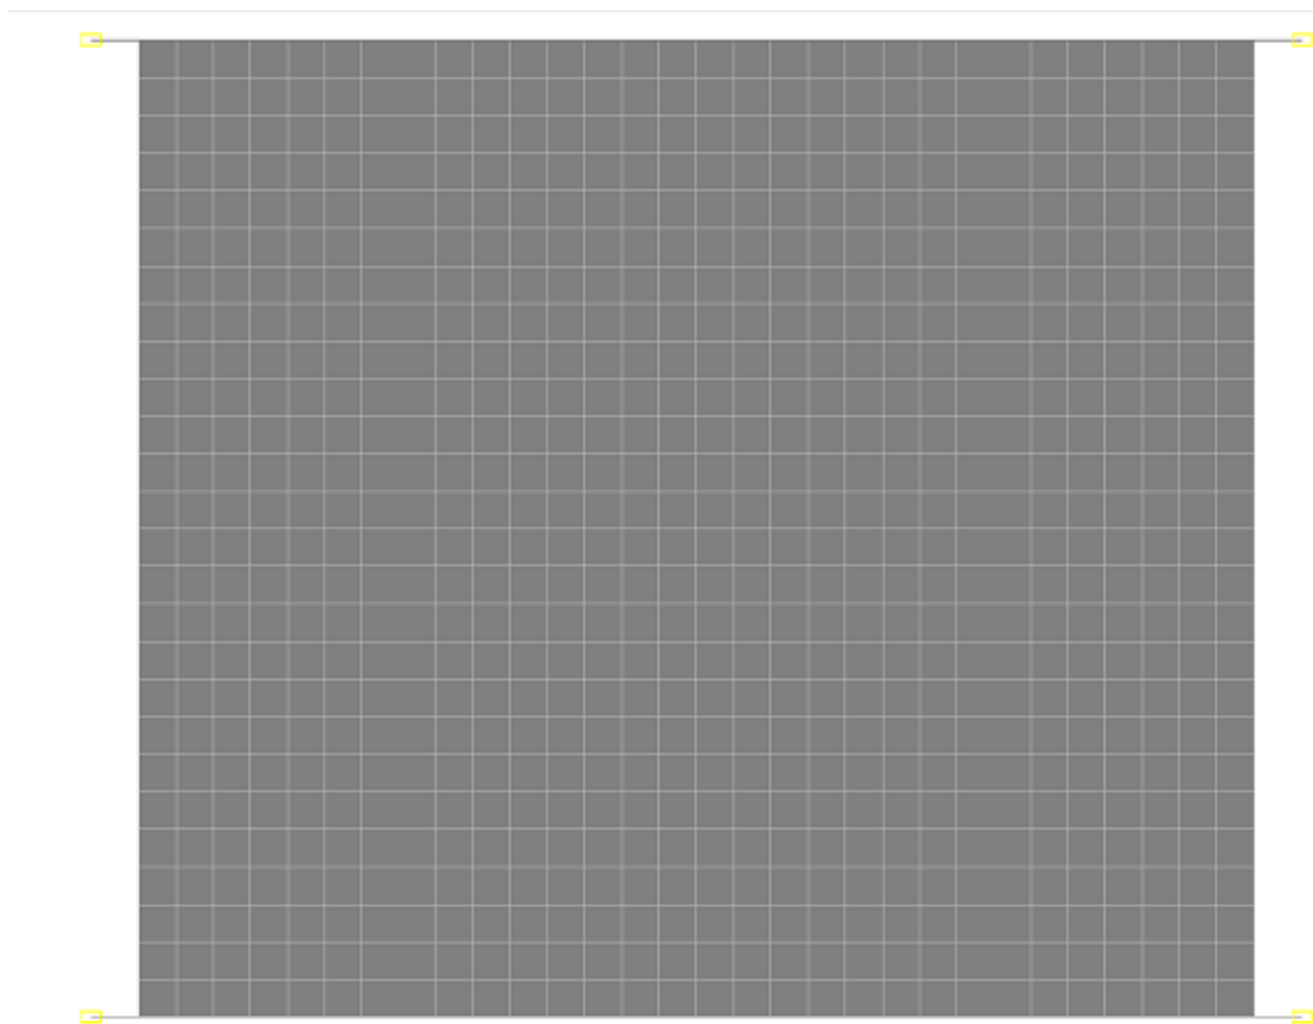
Расчетная схема монолитной плиты перекрытия.
